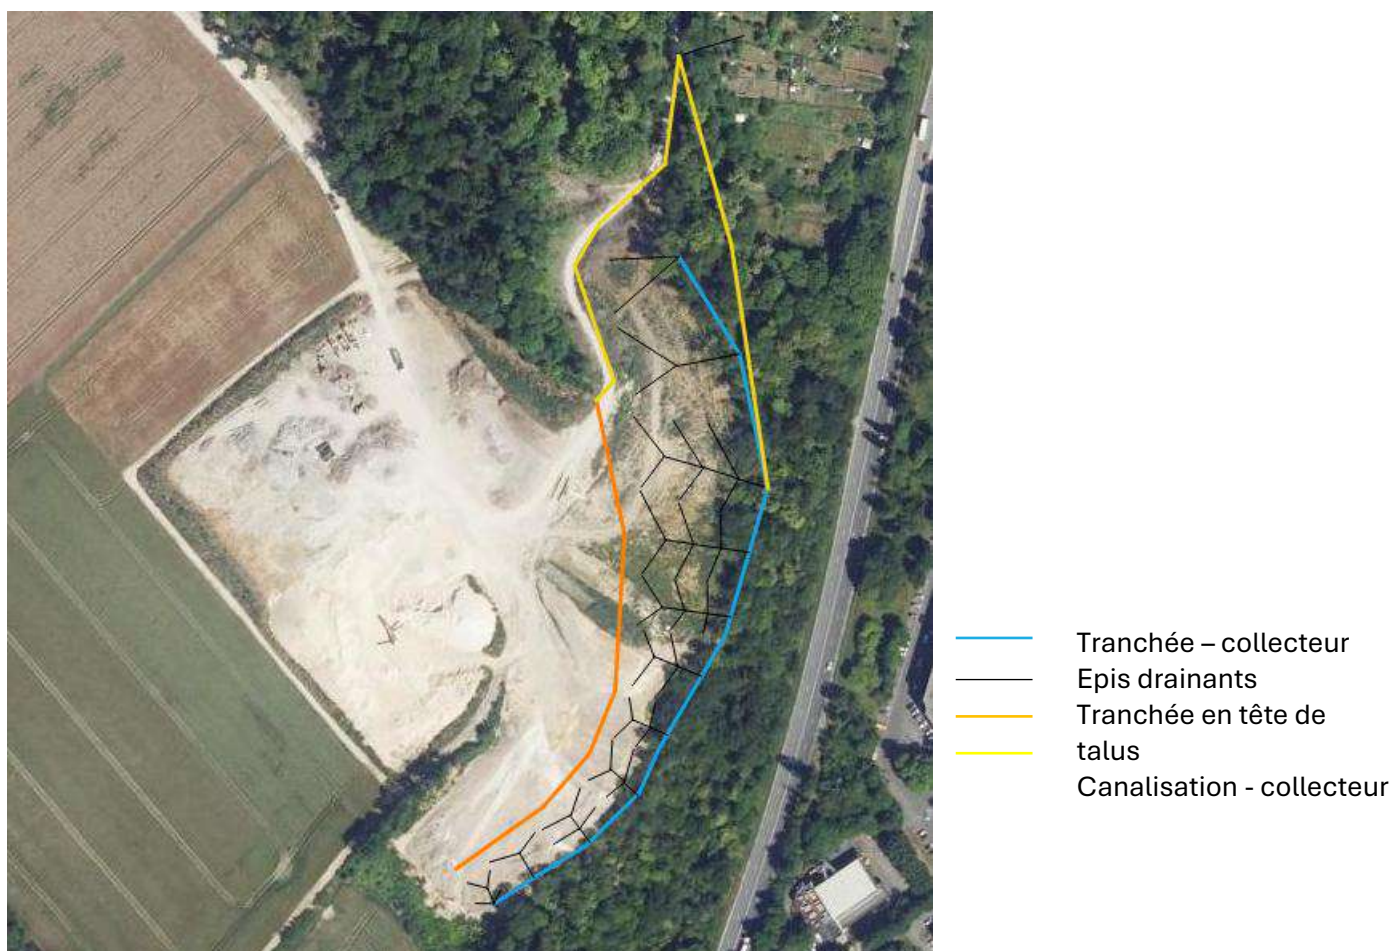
schéma de principe de la collecte des eaux pluviales par tranchées et épis drainants, zone Sud
